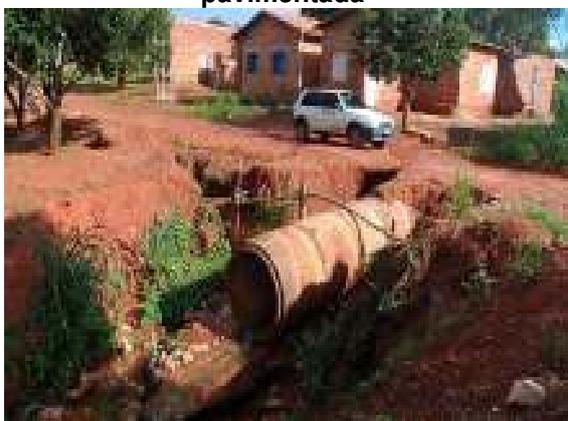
Erosão em via não pavimentada (tubos de drenagem aparentes)
